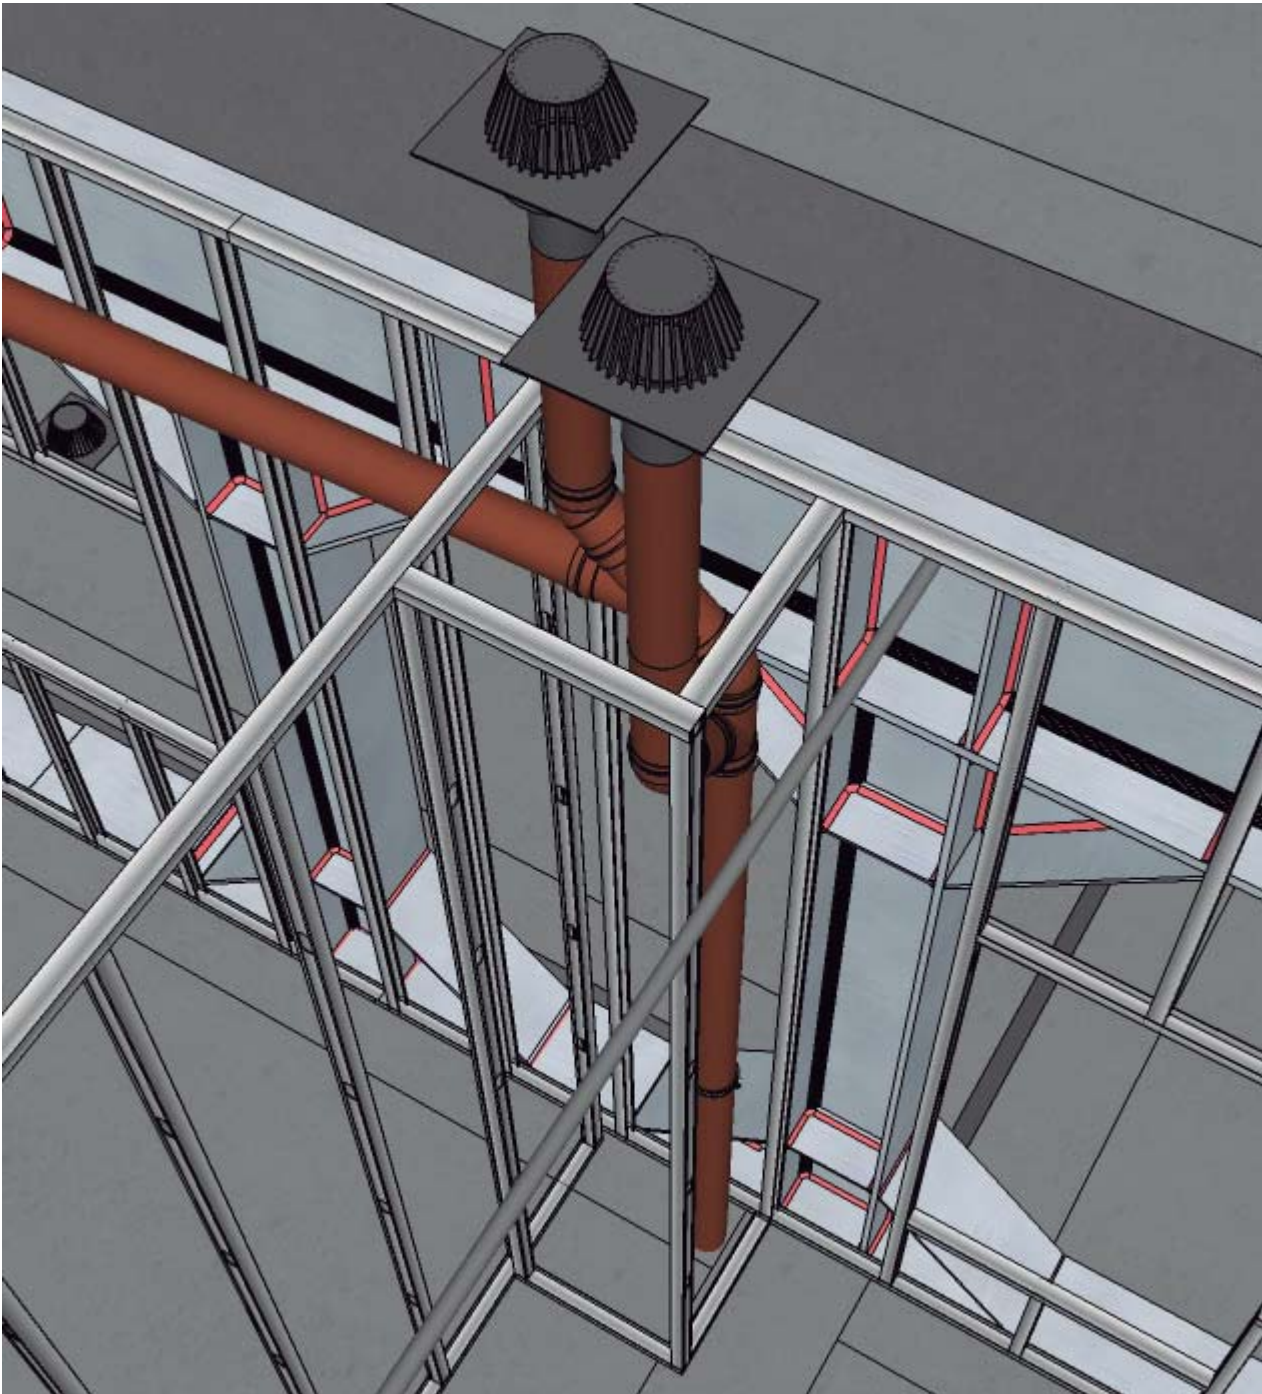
Detalle de las bajantes de pluviales y su cierre mediante tabiquería de pladur
